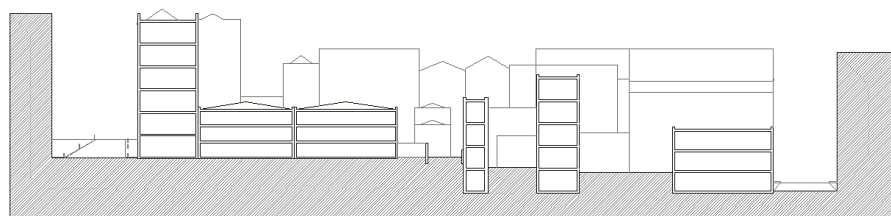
Corte do quarteirão e perfil dos arruamentos: Rua do Dr. Magalhães Lemos, Travessa dos Congregados e Rua de Sampaio Bruno.
